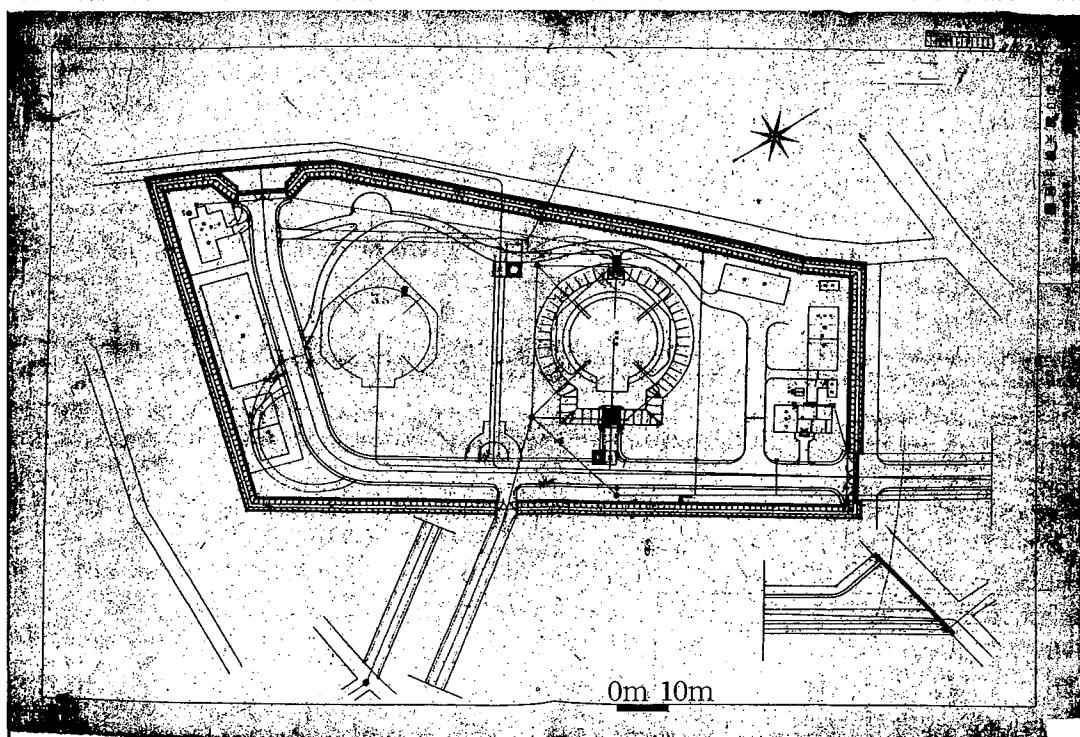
大谷口配水塔平面図(出典『荒玉水道誌 前編』)
